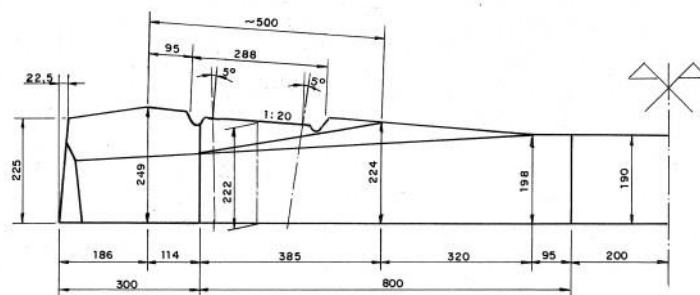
Alzado Traviesa MR-93 (Fuente: ADIF)
